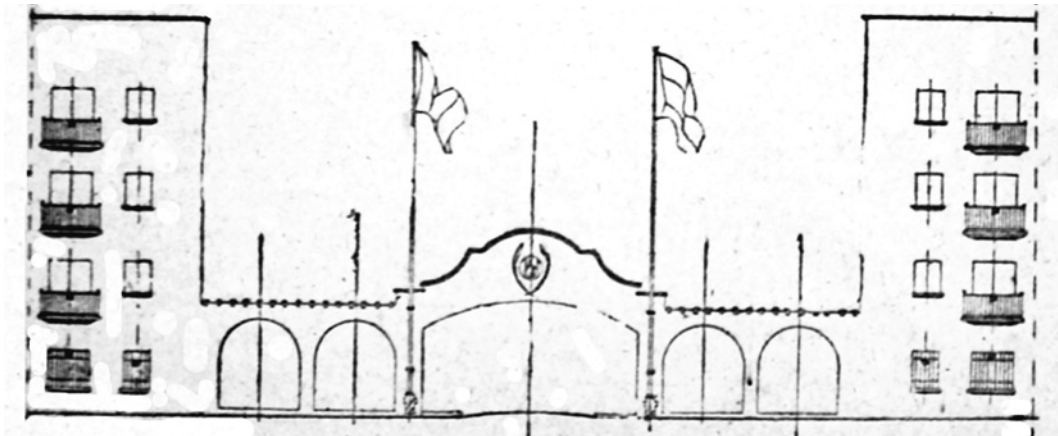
/ Viviendas sindicales, puerta de entrada al patio central
